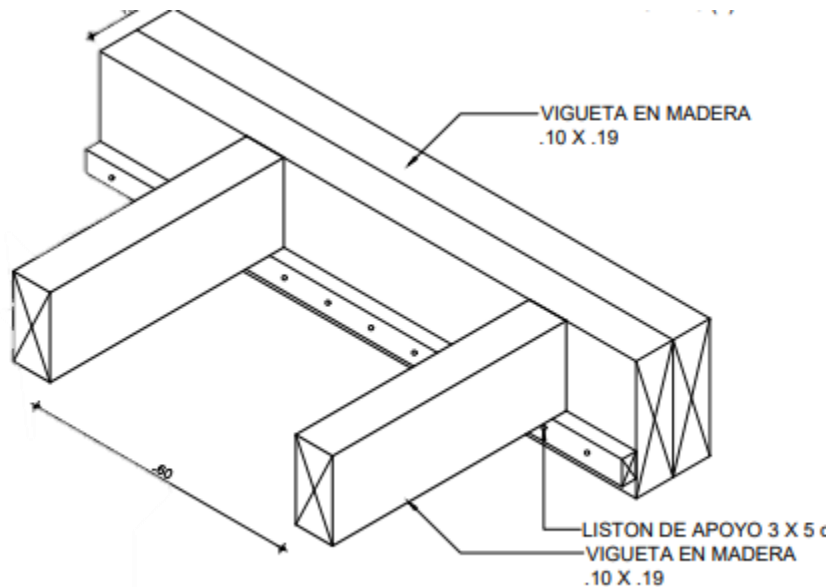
Detalle de uniones entre las viguetas de madera y las vigas. Fuente: Elaboración propia.
